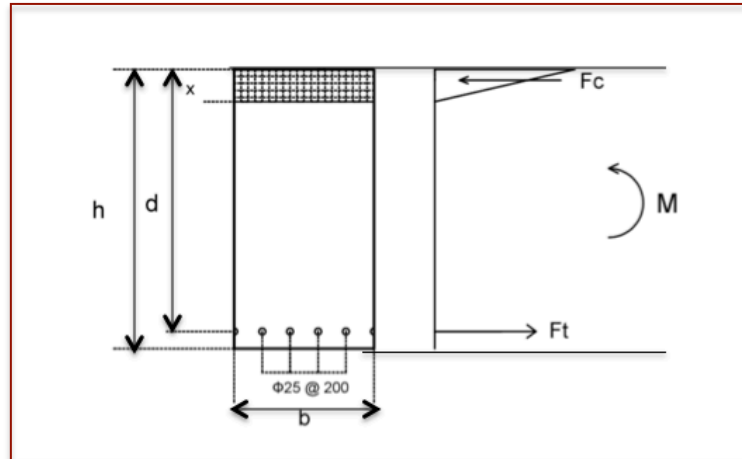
Seção transversal da viga de betão armado a analisar.
